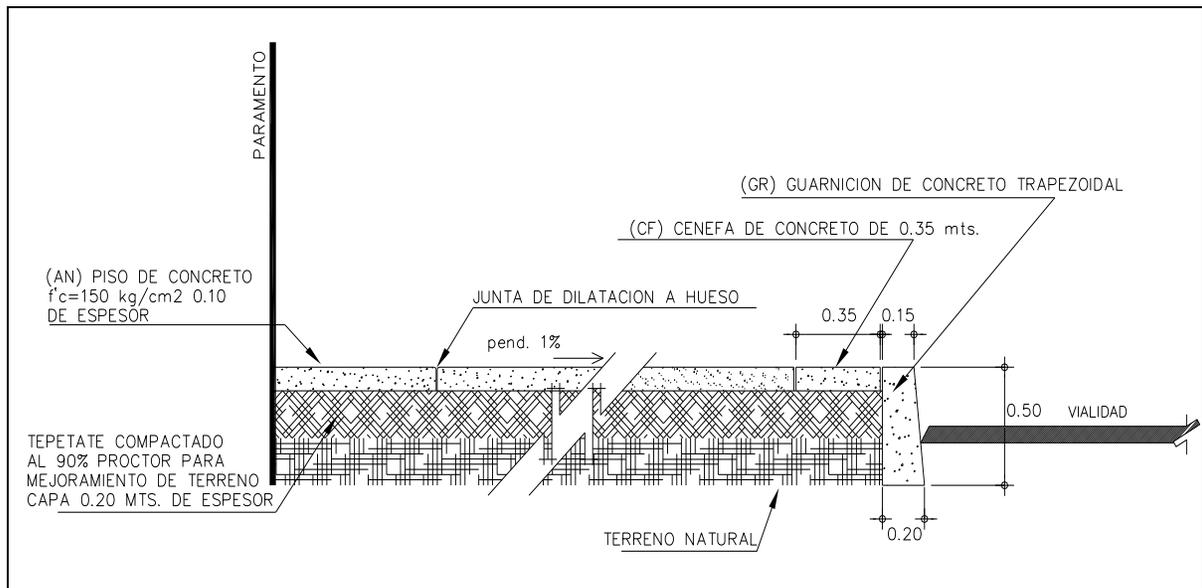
Detalle de Banquetas situadas debajo del Distribuidor Vial Periférico-Muyuguarda, acotaciones en cm.
